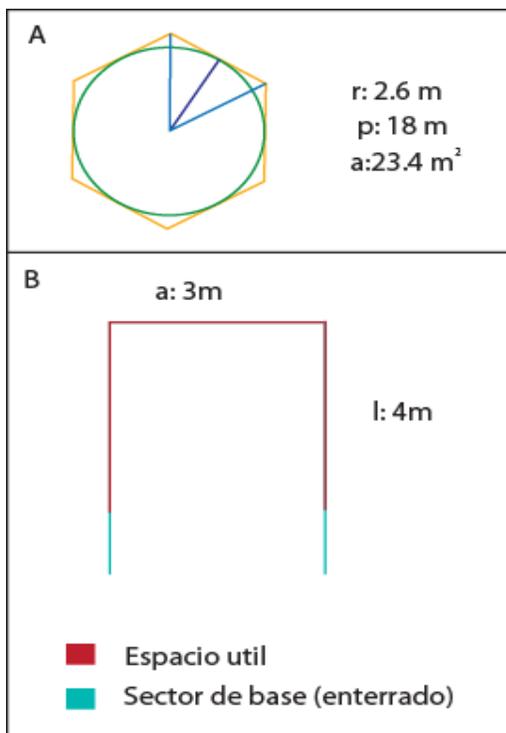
A. dimensiones de las estructuras superiores, B. dimensiones de estructuras laterales
